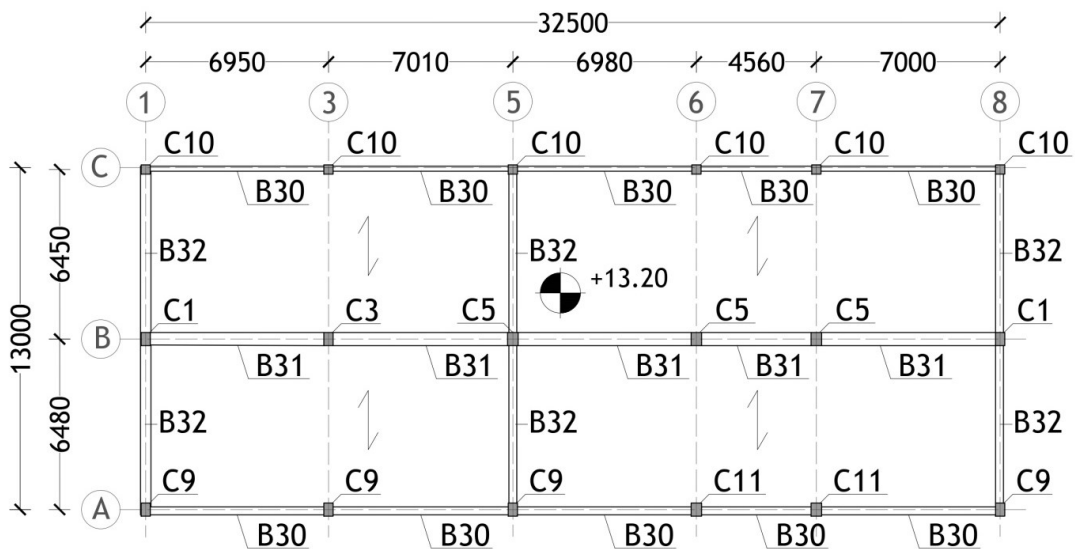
Pianta strutturale del piano sottotetto a quota +13.20 m
